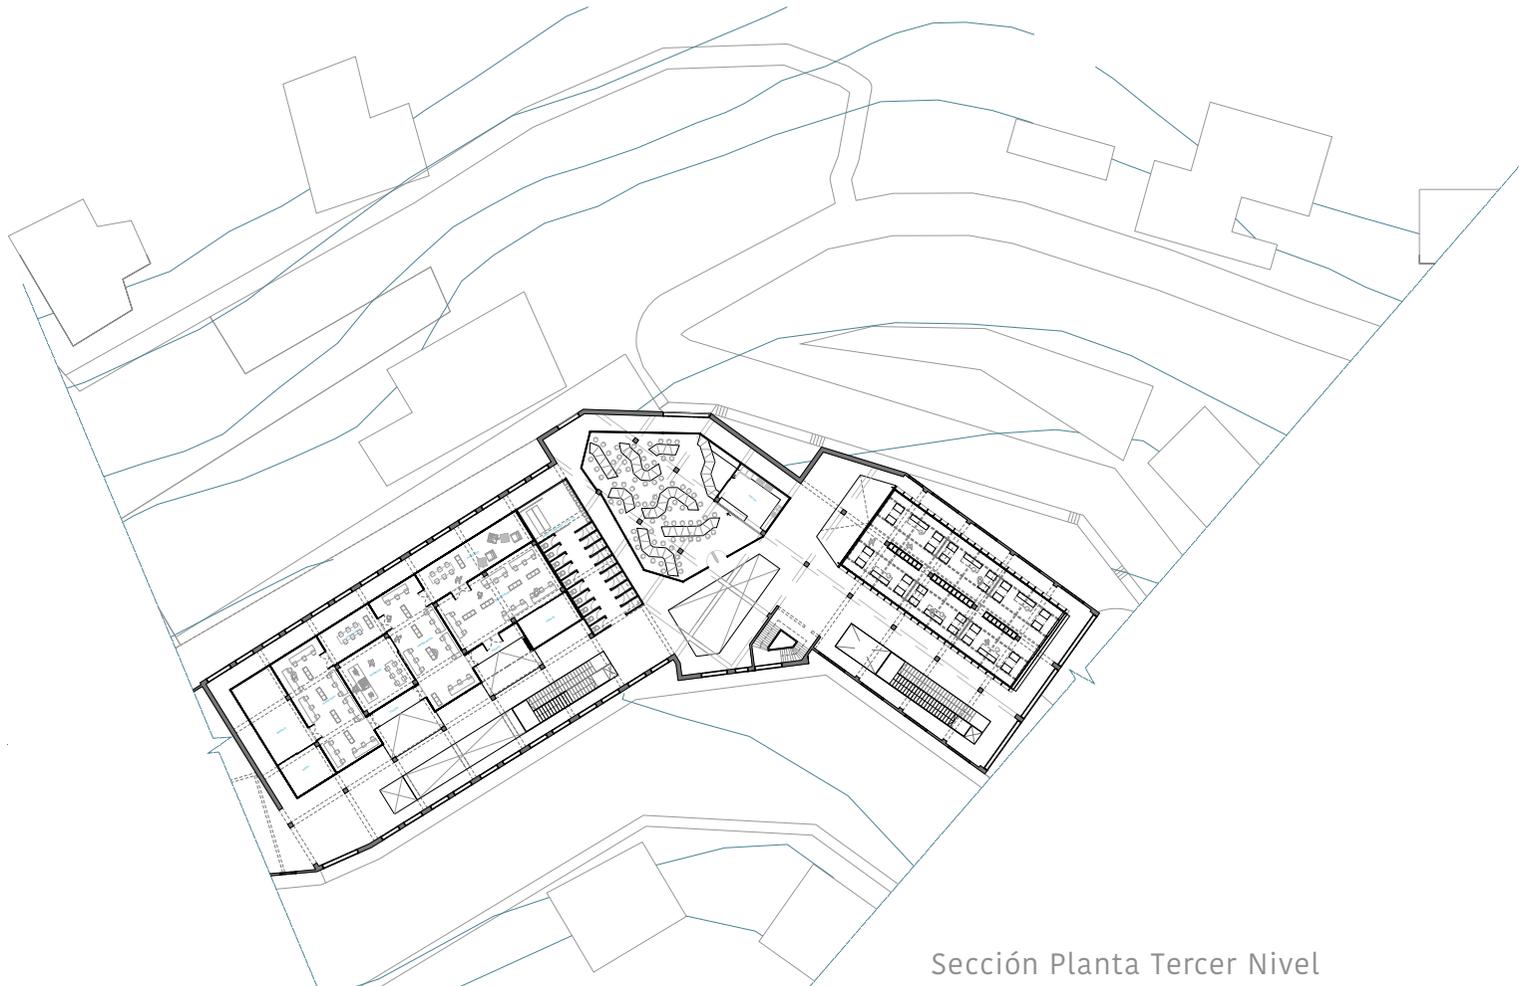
Plantas de desarrollo arquitectónico. Fuente: Elaboración propia.
